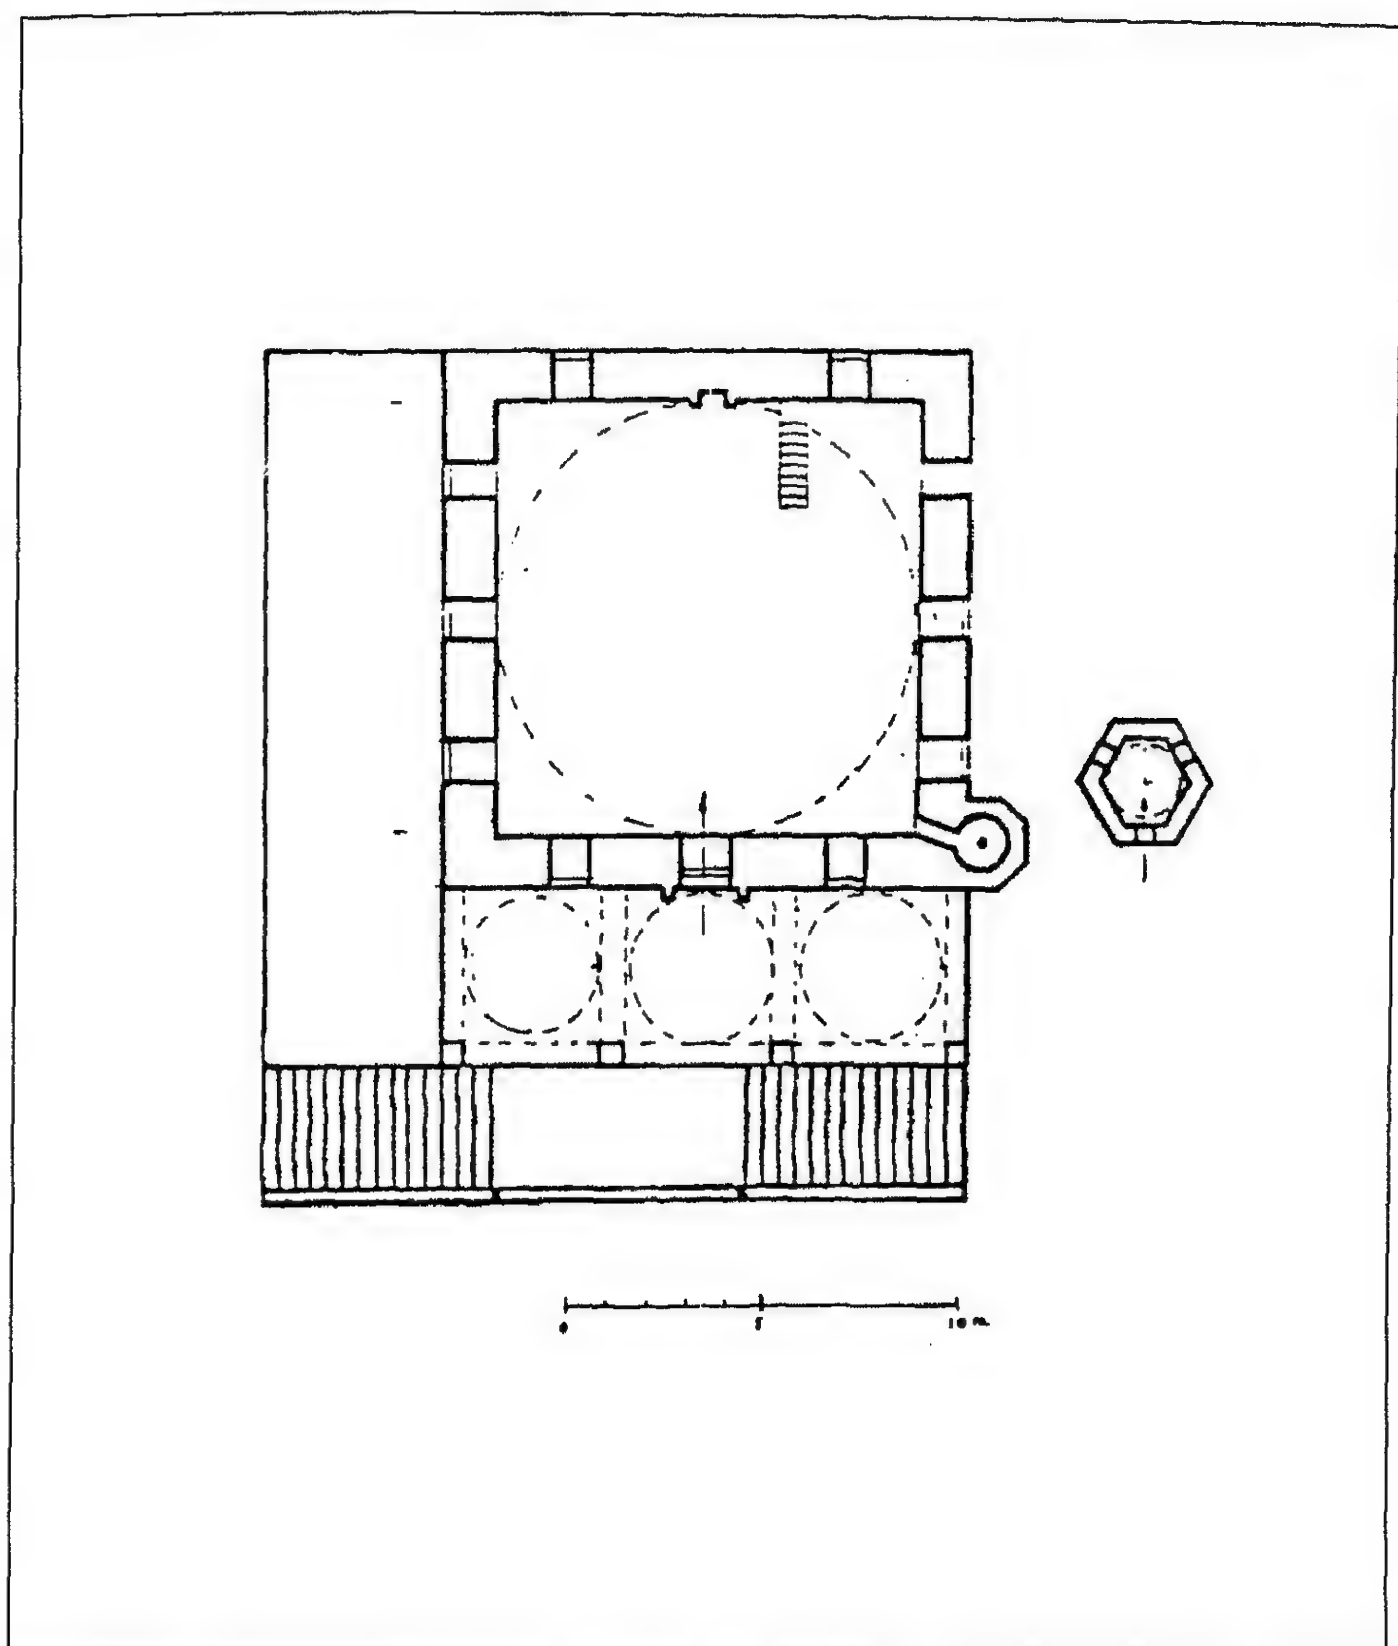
مسقط أفقي لمسجد قيرشنلو في بيرات (عن : كيل) .
